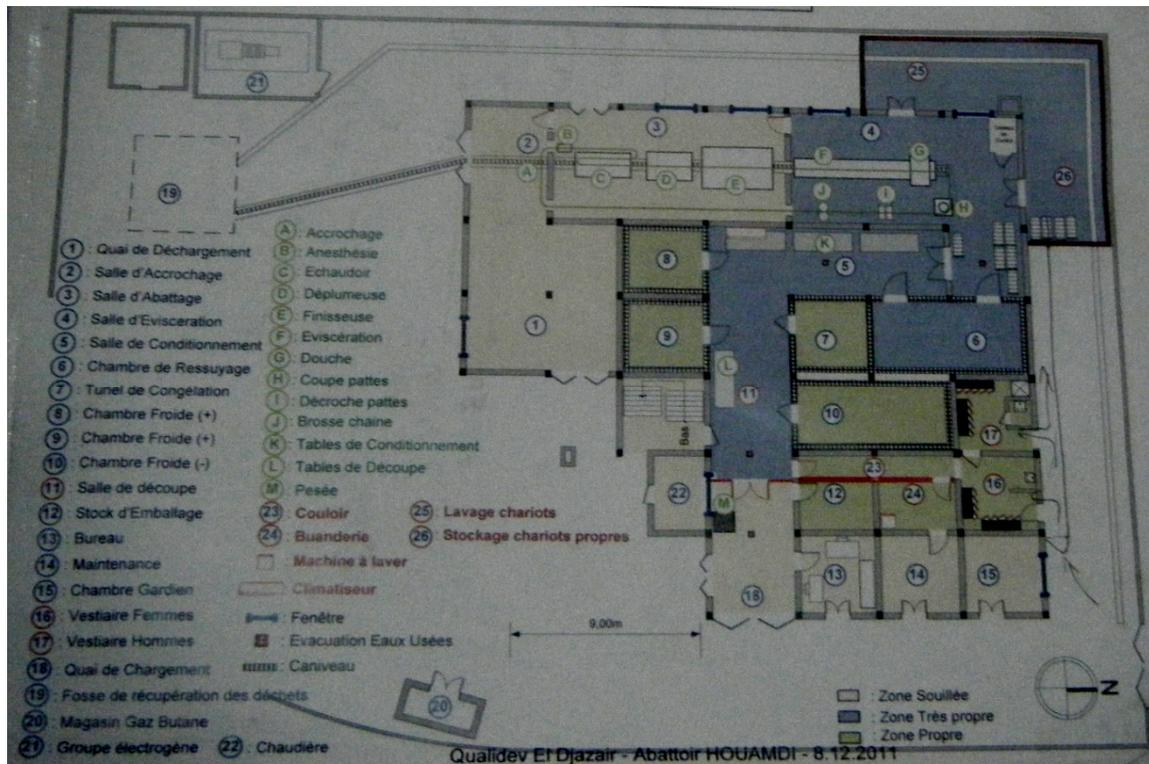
Plan de masse de l'abattoir Houamdi (photo personnelle)
